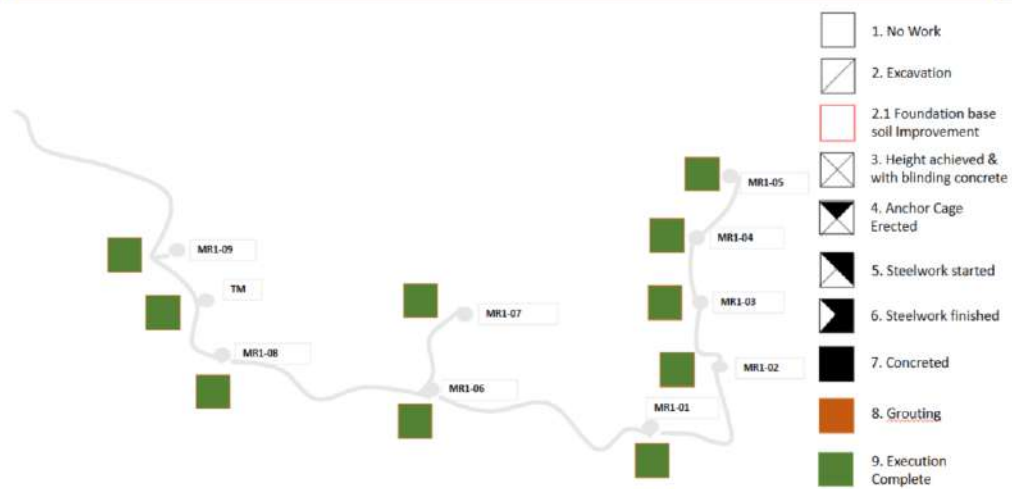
Estado y plano de obras ejecutadas a fin de mes.
